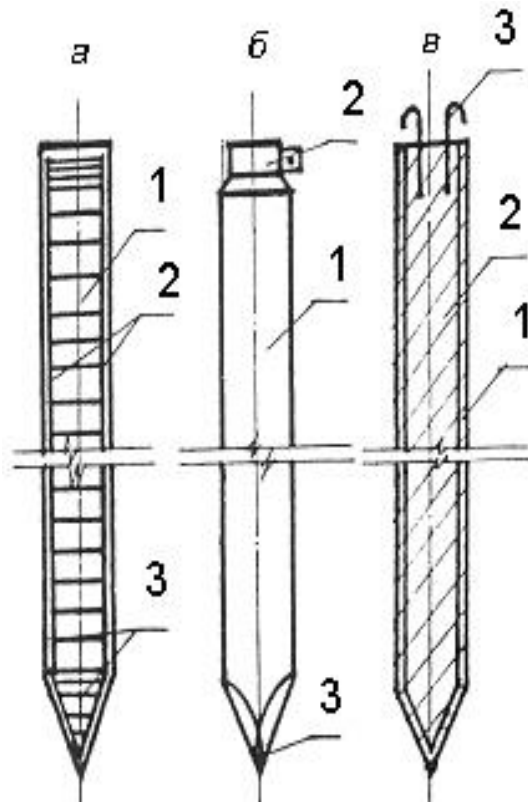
Види палі: а – залізобетонна; 1 – бетон; 2 – поздовжня арматура; 3 – поперечна арматура; б – дерев'яна; 1 – стовбур; 2 – бугель (обруч); 3 – черевик з металу; в – металева; 1 – труба; 2 – бетон; 3 – арматура
